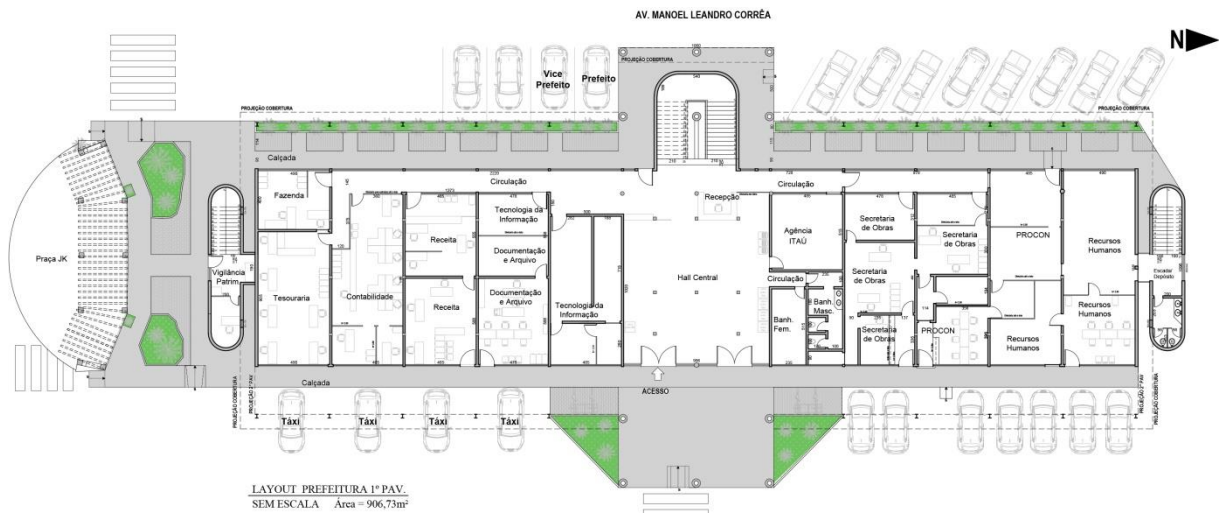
Planta Baixa do 1º Pavimento da Prefeitura com calçadas em Destaque.
